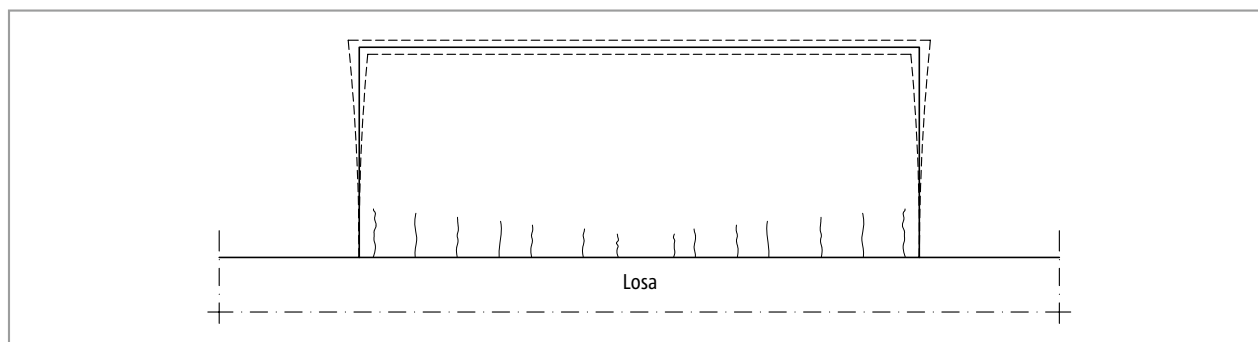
Losa de balcón sin Schöck Isokorb®: Posibilidad de agrietamiento debido a la fatiga
